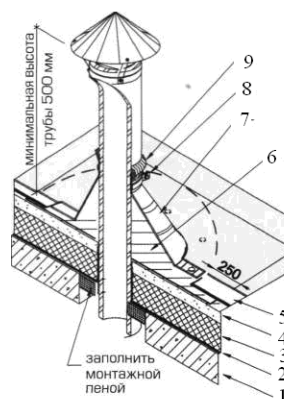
Устройство примыкания рулонной кровли к трубе:
